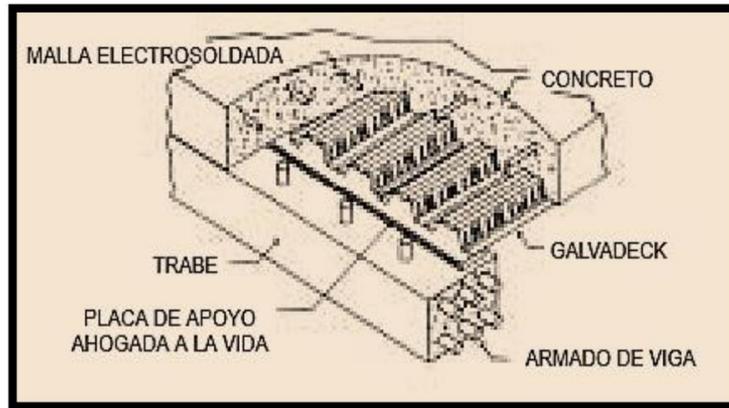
instalación en estructuras de concreto por medio de placas de anclas ahogadas
